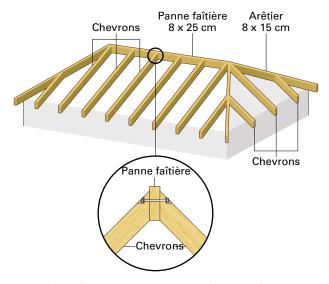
Exemple de fixation des chevrons sur la panne faîtière par un boulon
